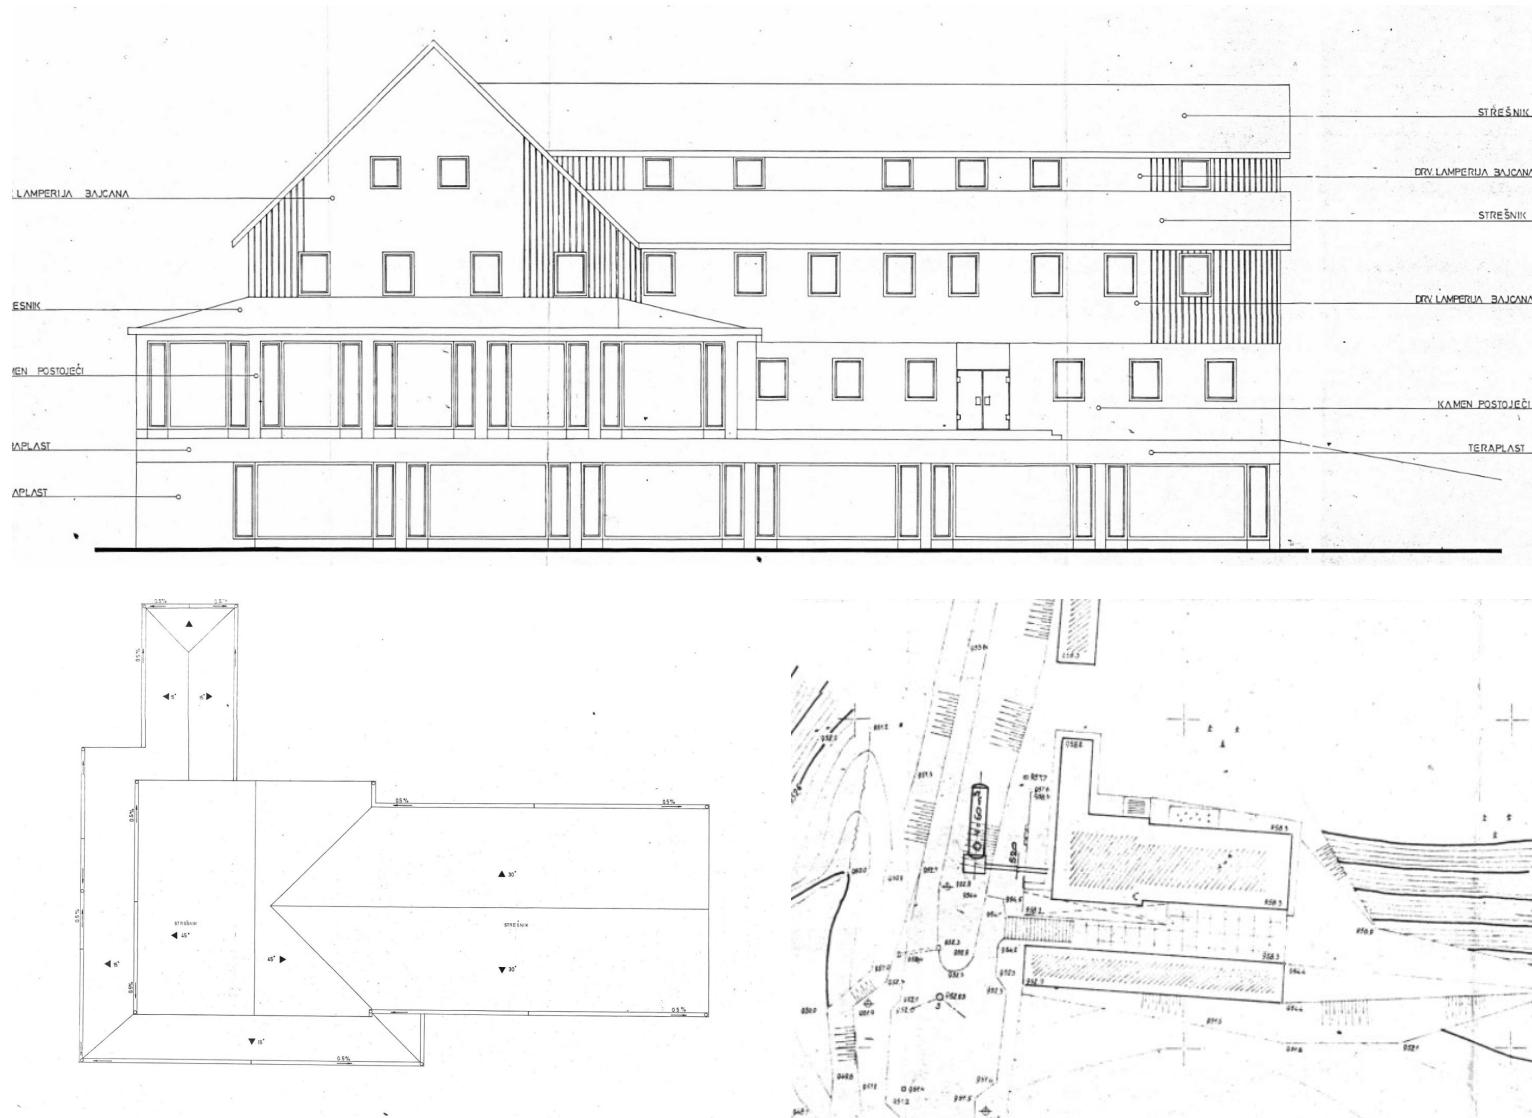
Hotelentwurf Lage 1978. Südfassade, Dach, Lage.
